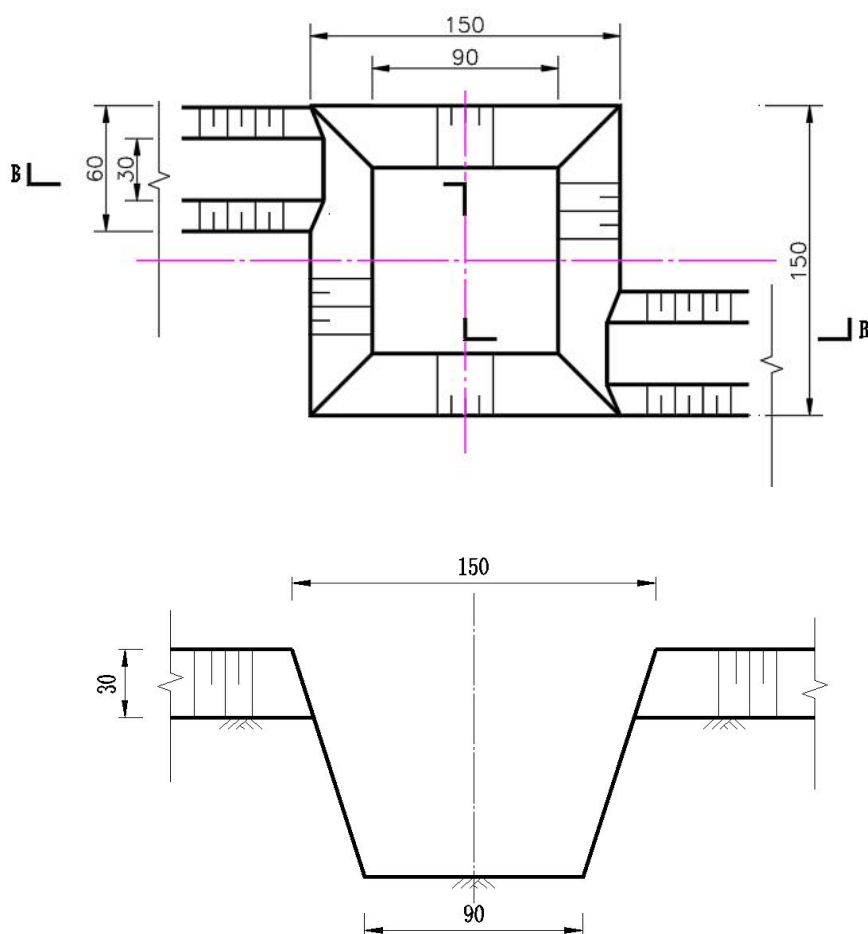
临时沉沙池典型断面图（单位：cm）
